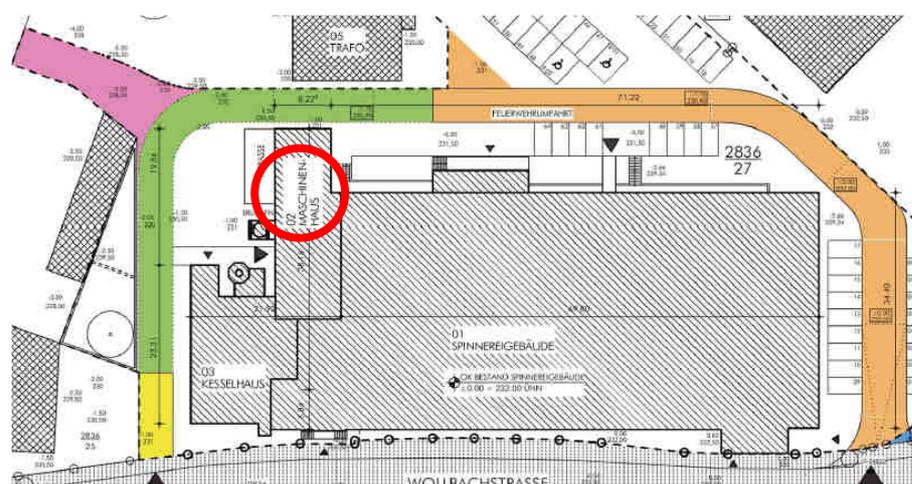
Übersicht Lageplan Wegrechte s.o. (Dienstbarkeiten)
